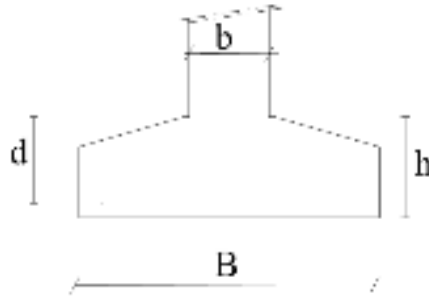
Dimensionnement d'une semelle isolée dans le sens y-y.
